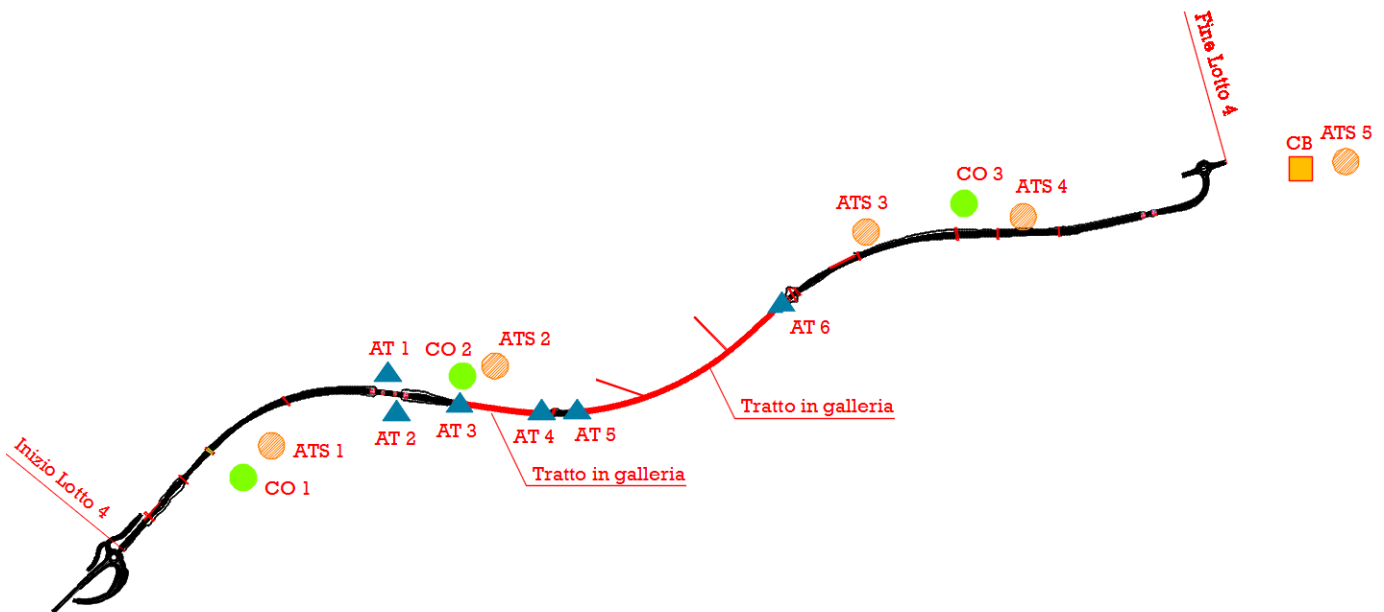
Localizzazione aree di cantiere lungo il tracciato
